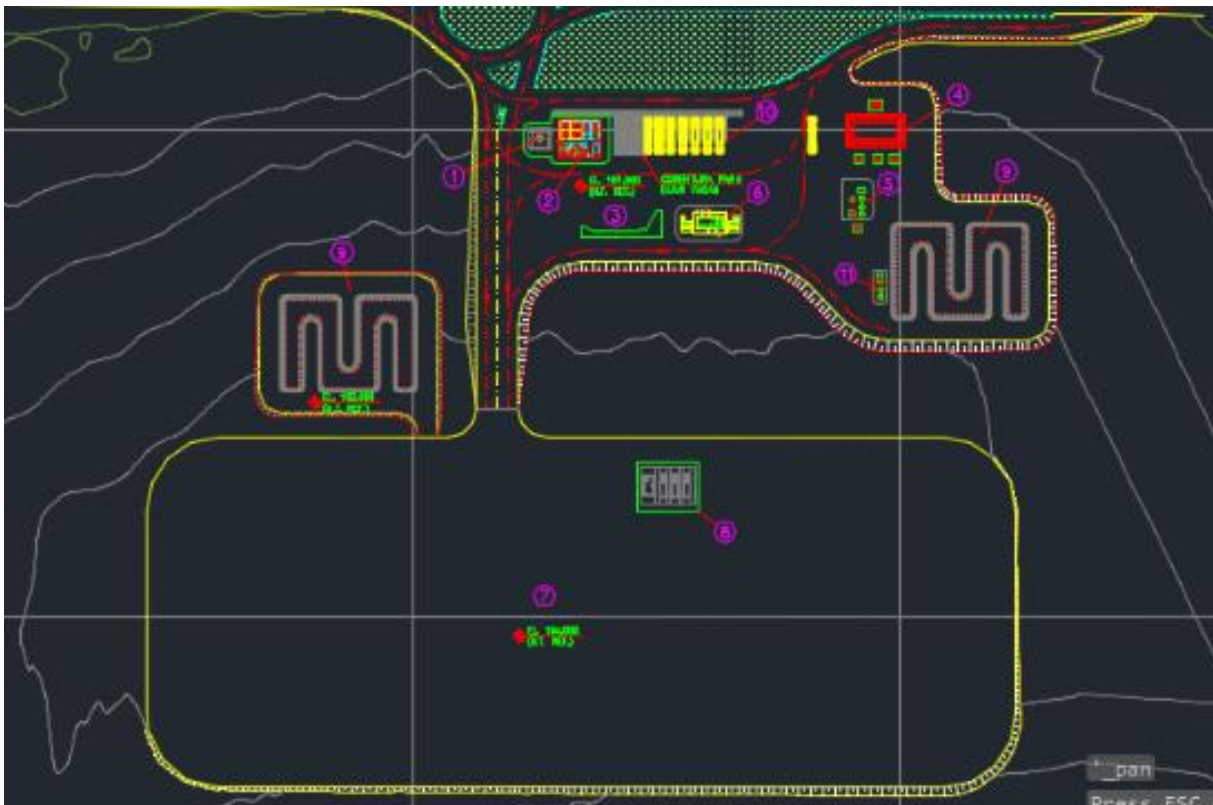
Layout das instalações provisórias na área Teófilo.
